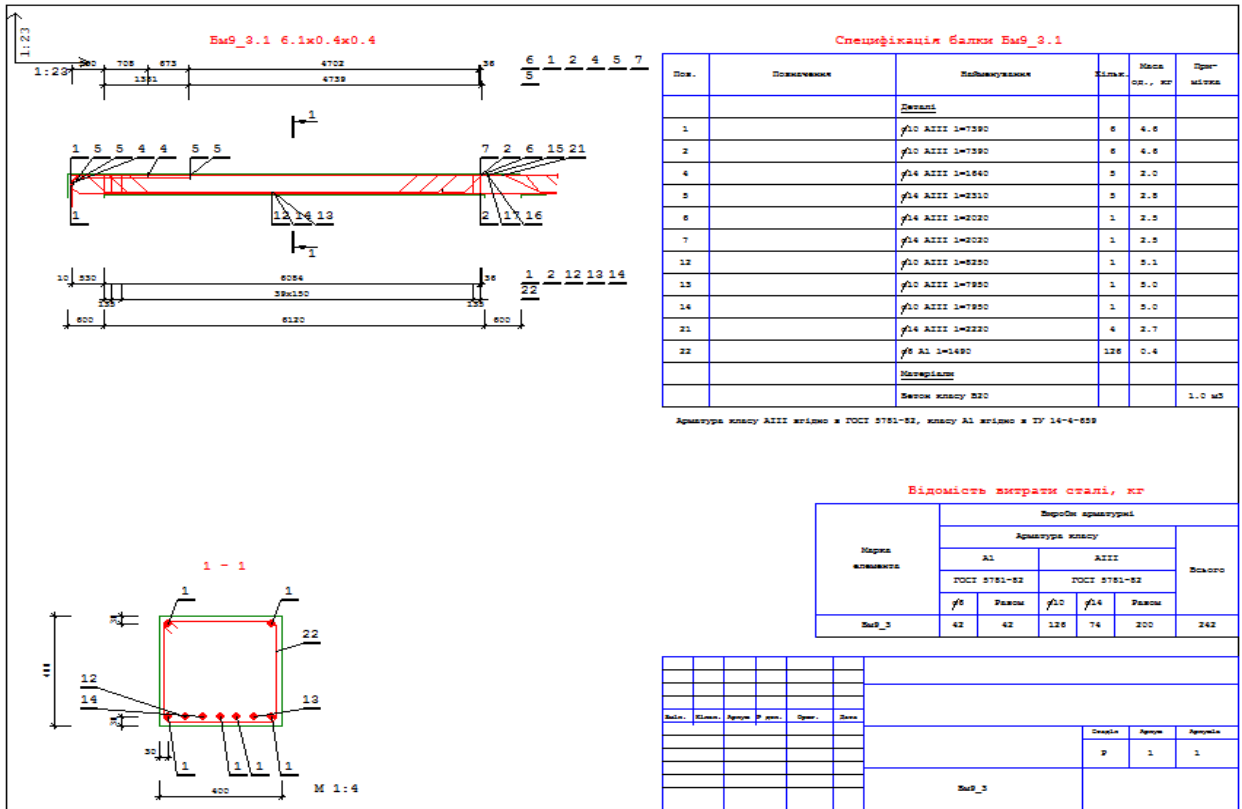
Варіант будинку з балочно - плитним перекриттям. Балка Б9-3. Креслення робочого проекту
